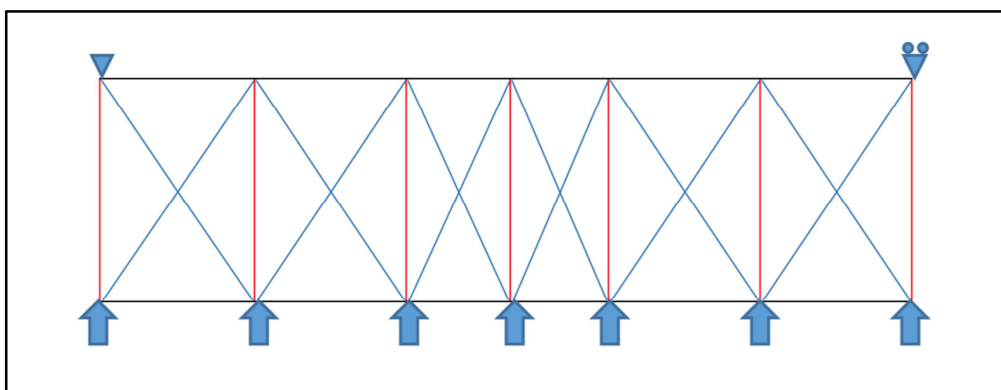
Viga contraviento tipo Pratt. Fuente: Elaboración Propia.
